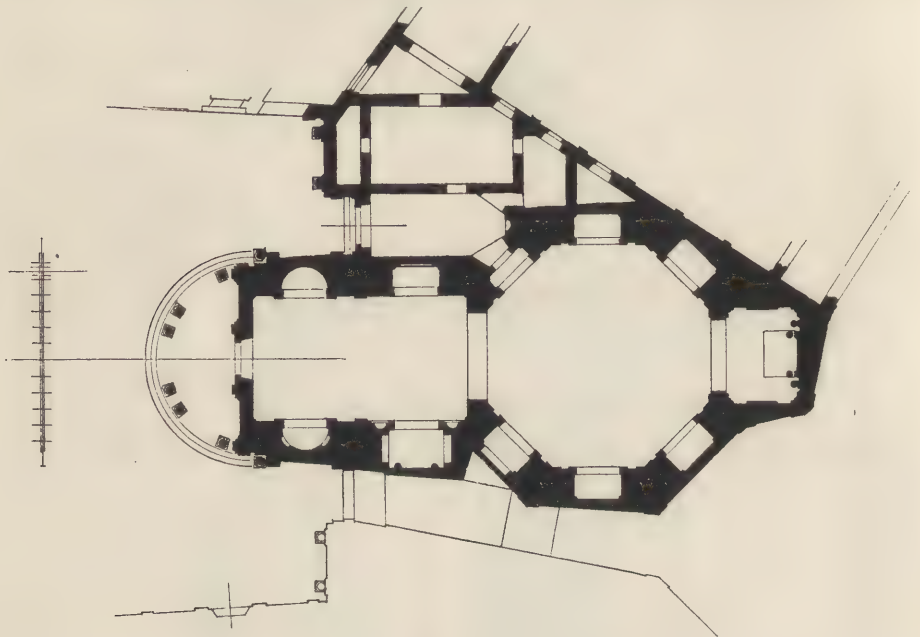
St. Maria della Pace zu Rom. Grundriß.
